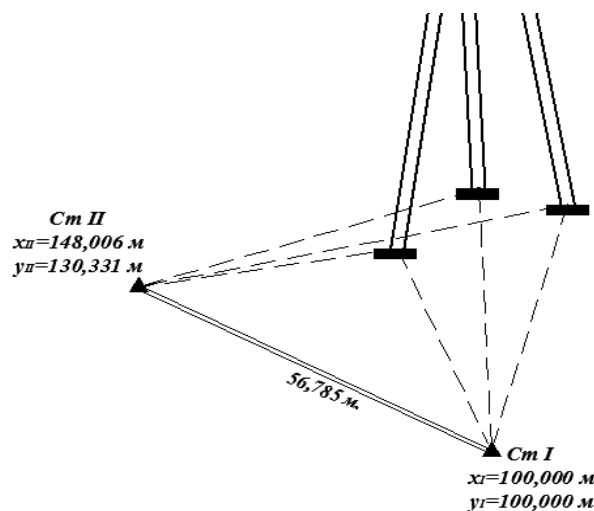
Схема измерений при проведении работ по определению крена треугольной башни
